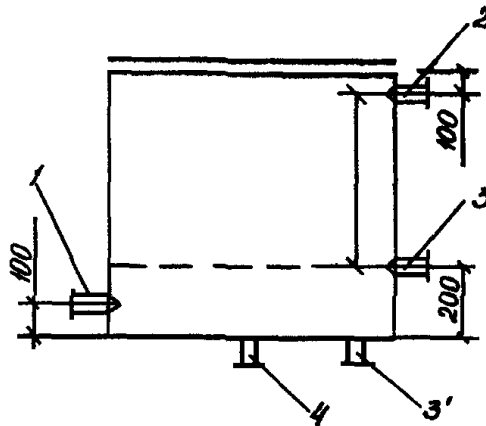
Відкритий розширювальний бак з патрубками для приєднання труб: 1 - розширювальний; 2 - переливний; 3 - контрольний (3' - реле рівня); 4 - циркуляційний
